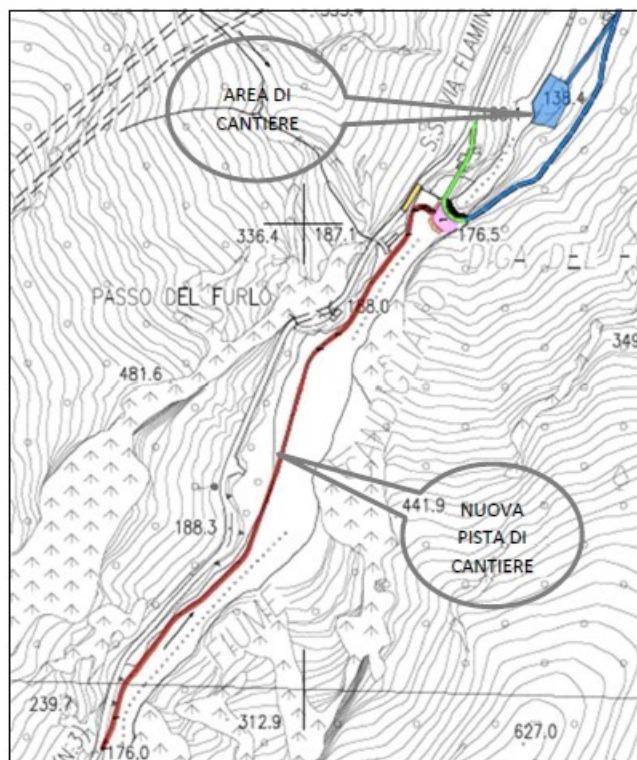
Stralcio planimetrico del tracciato della nuova pista di cantiere
